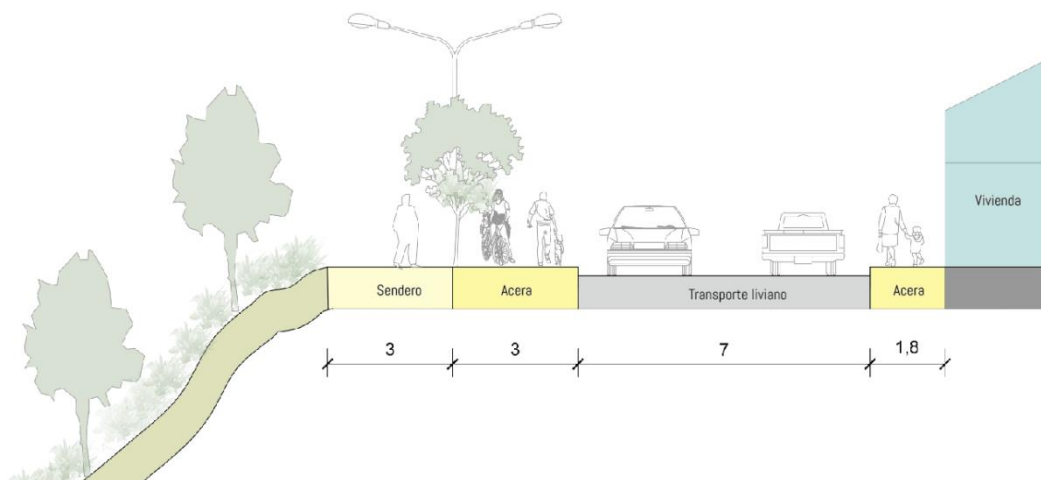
Sección de vía perimetral y conectora. Fuente: Elaboración propia.
